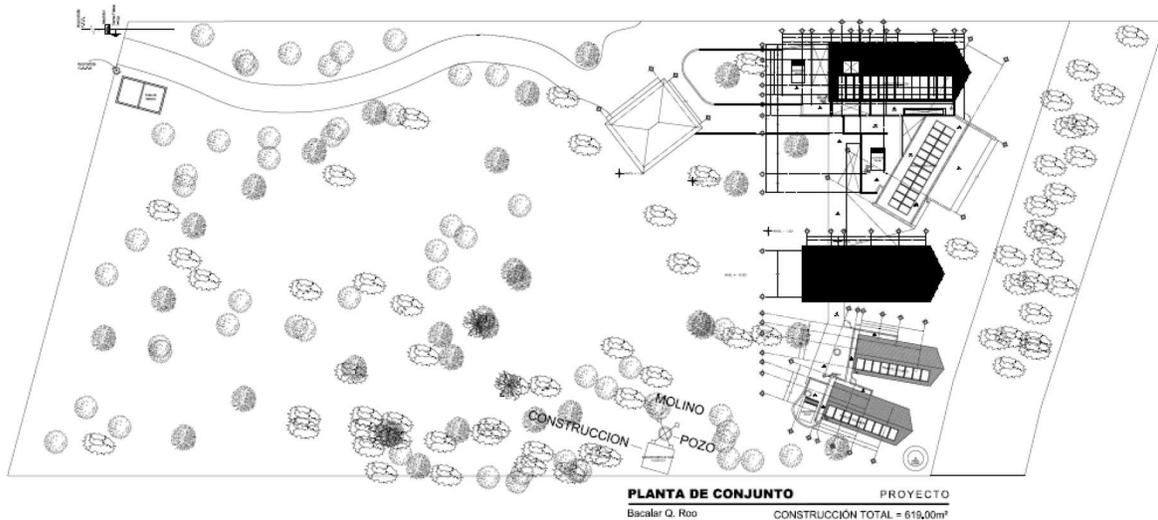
Plano arquitectónico de conjunto proyecto CASA CAMINO AL VIENTO.
